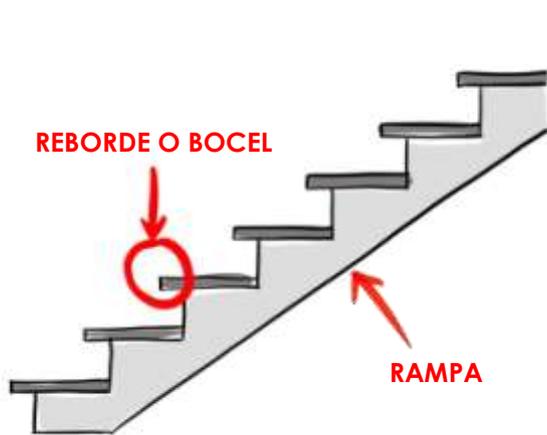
Sección longitudinal de una escalera. Fuente: elaboración
